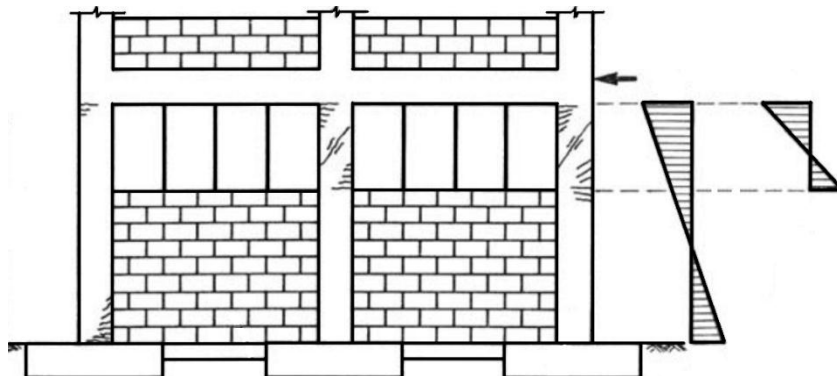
Pilar curto, devido à descontinuidade em altura provocada pela parede de alvenaria.
